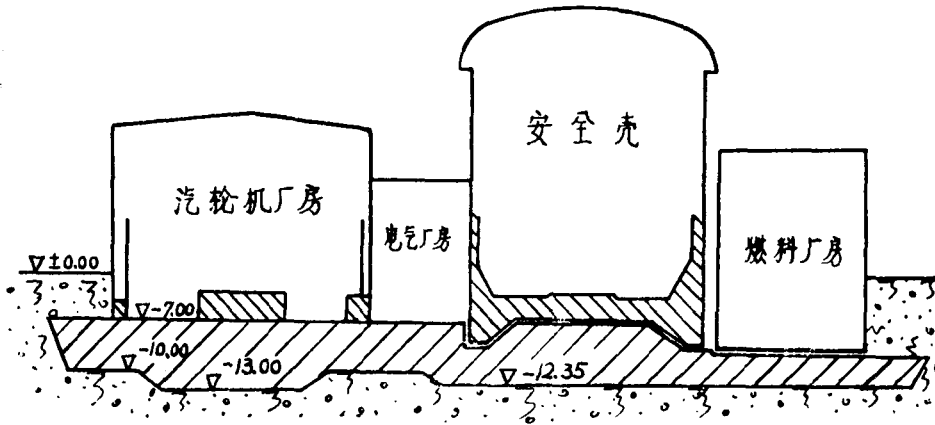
格拉芙利纳电站钢筋混凝土大平台
